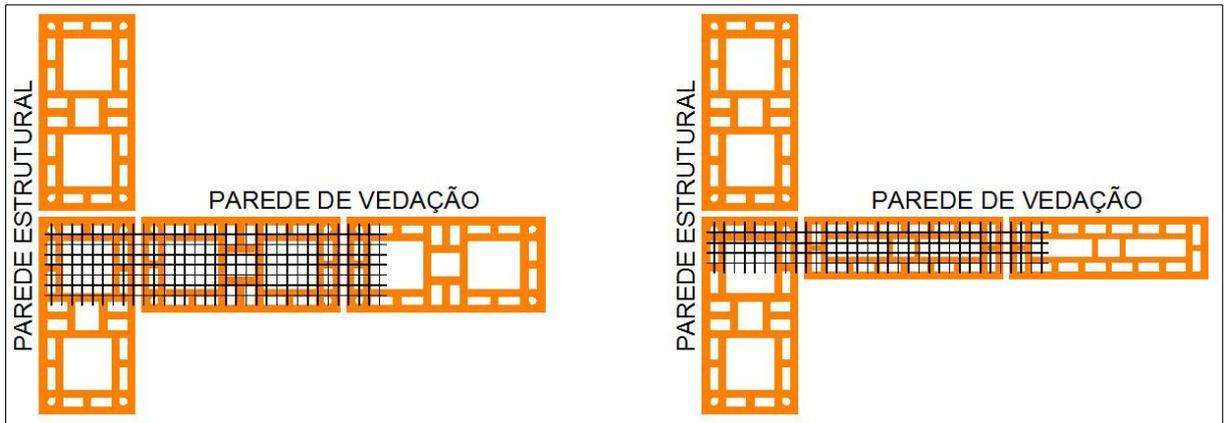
Detalhe de colocação de telas para amarração de paredes.
